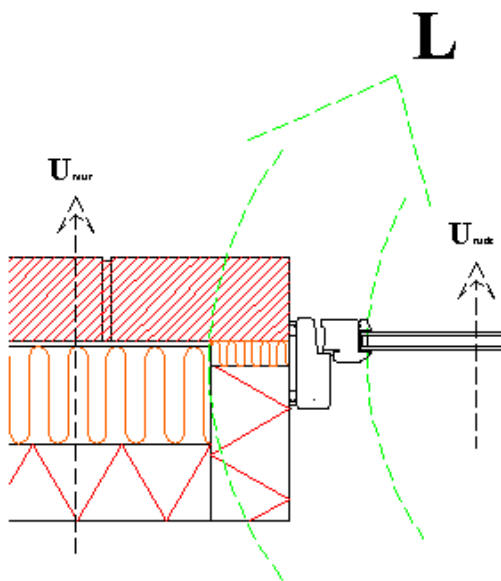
Ramme-karmkonstruktion af blandede materialer med murløsning med 190 mm isolering og 32 mm kuldebroisolering
